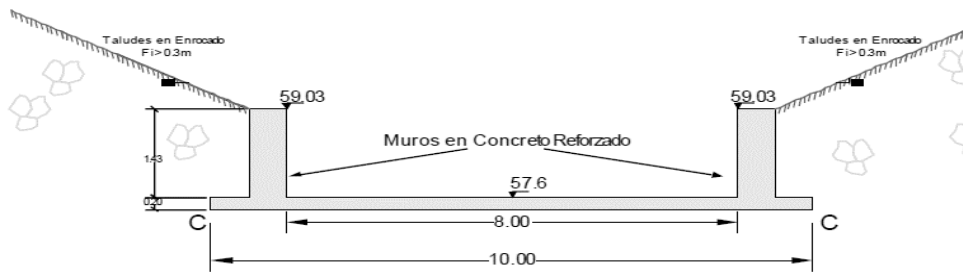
Sección transversal típica en la estructura de disipación de energía del Caño Piedras. Corte C-C.
